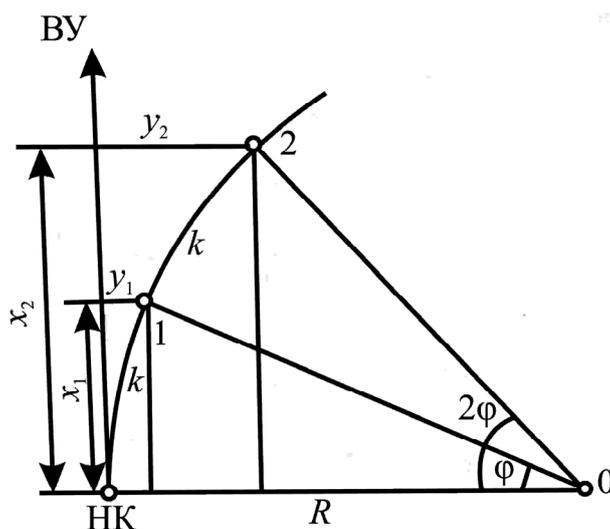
Детальная разбивка круговой кривой способом прямоугольных координат
